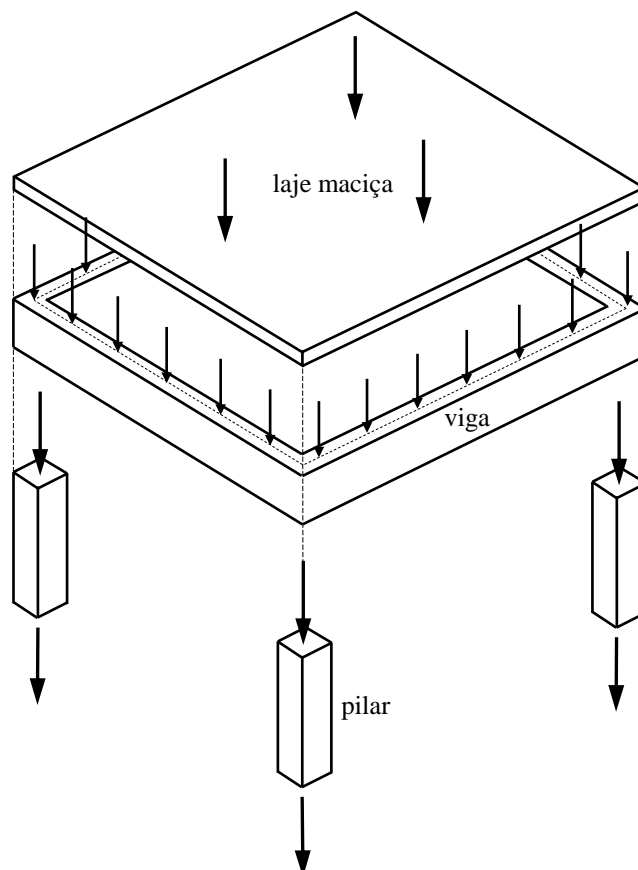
Caminhamento das cargas verticais no sistema estrutural tradicional com laje maciça.
